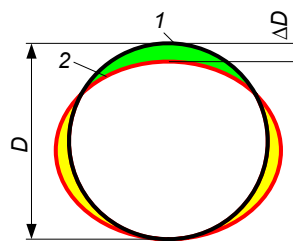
Схема деформування поперечного перерізу металеві гофрованої труби: D – проектний діаметр поперечного перерізу труби;  $\Delta D$  – величина деформування; 1 – проектне положення; 2 – деформований стан
